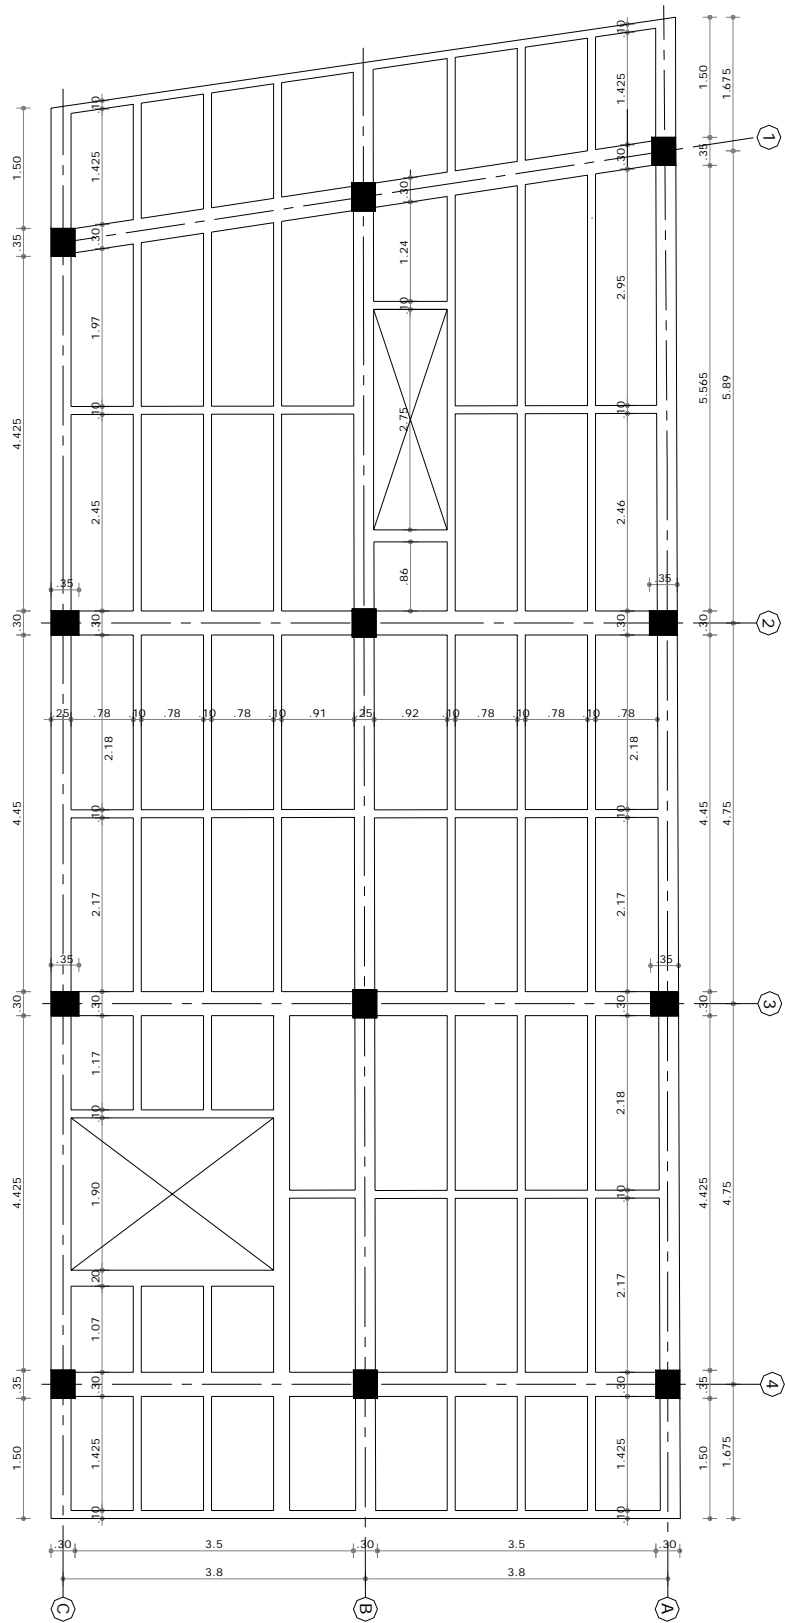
Planta estructural del primer entrespacio de la edificación tipo.
